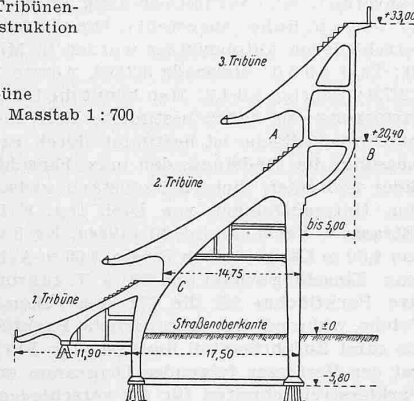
Untersicht der Tribünen-Eisenbeton-Konstruktion
